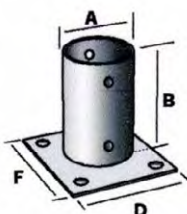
Apoyo de pilar tradicional metálico (fuente: www.bricomark.com).
